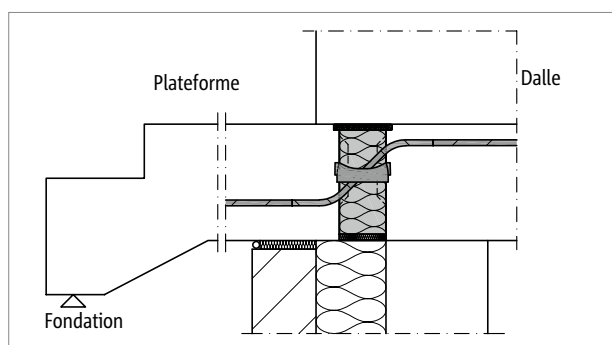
Schöck Isokorb® T Type Q-E-V : Raccordement de volée d'escaliers
